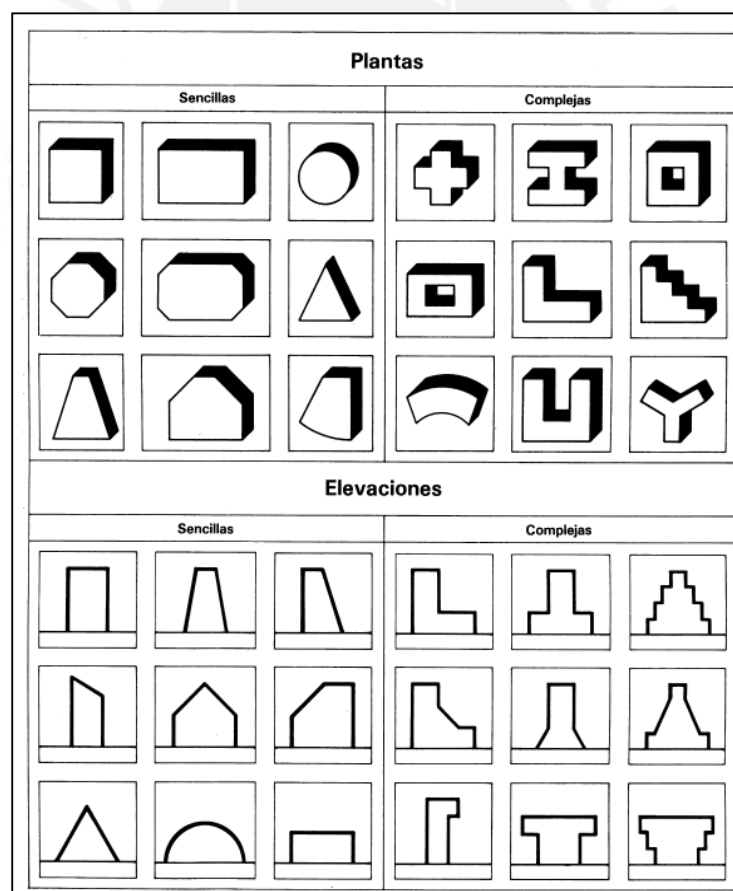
Plantas y elevaciones en una configuración estructural (Arnold y Reitherman 1987)
